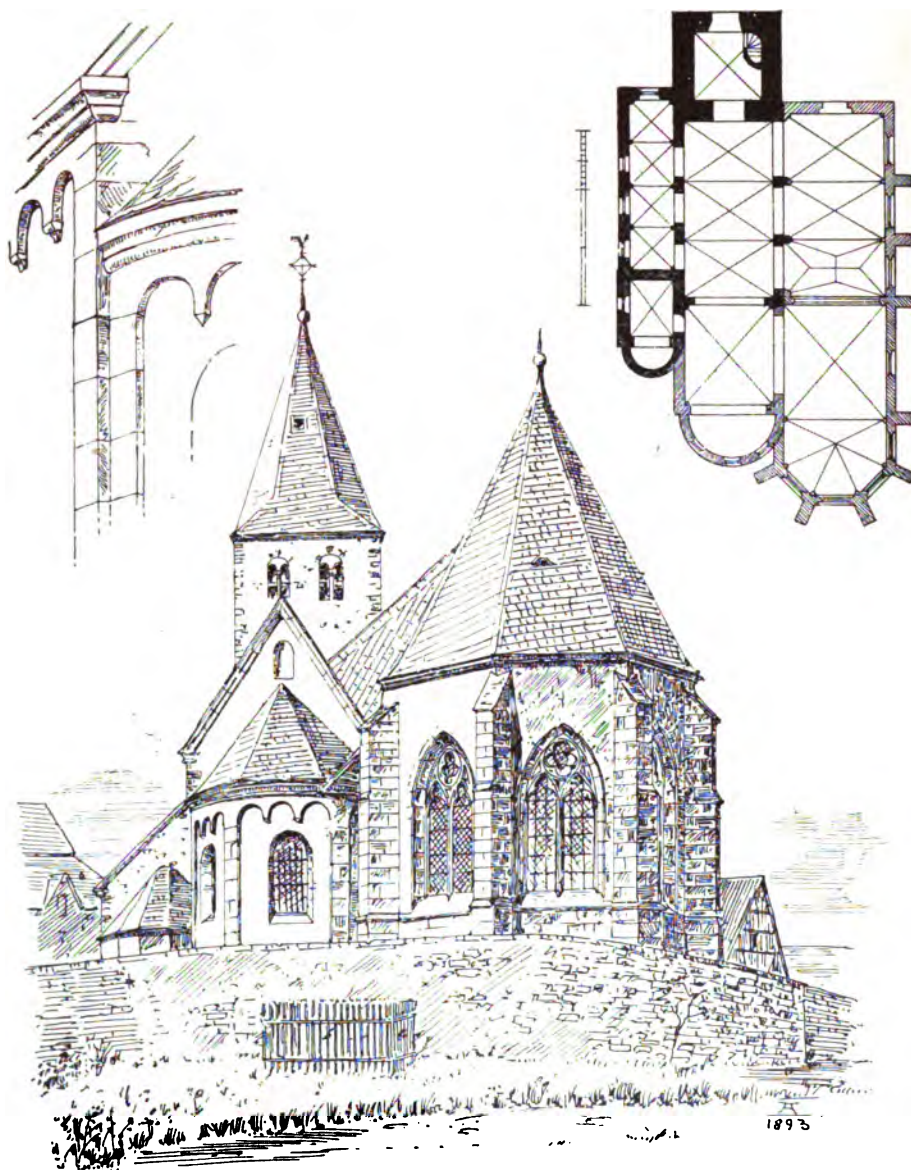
Frauenberg, Katholische Pfarrkirche. Choransicht, Grundriss und Detail.
